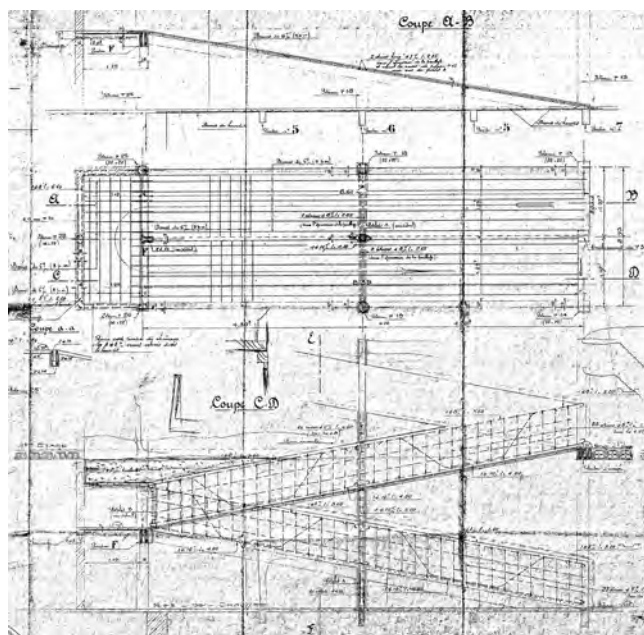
Detalle del plano de la rampa de subida a planta primera de la *Villa Savoye* (FLC-H1-13-305). Fuente: Fondation Le Corbusier.
